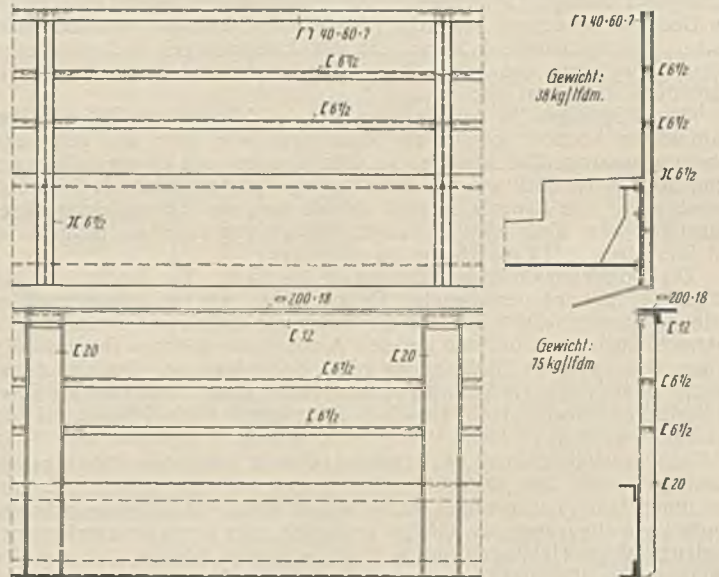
Druckgurte von Fachwerken — Ausgesteifte Wände.
